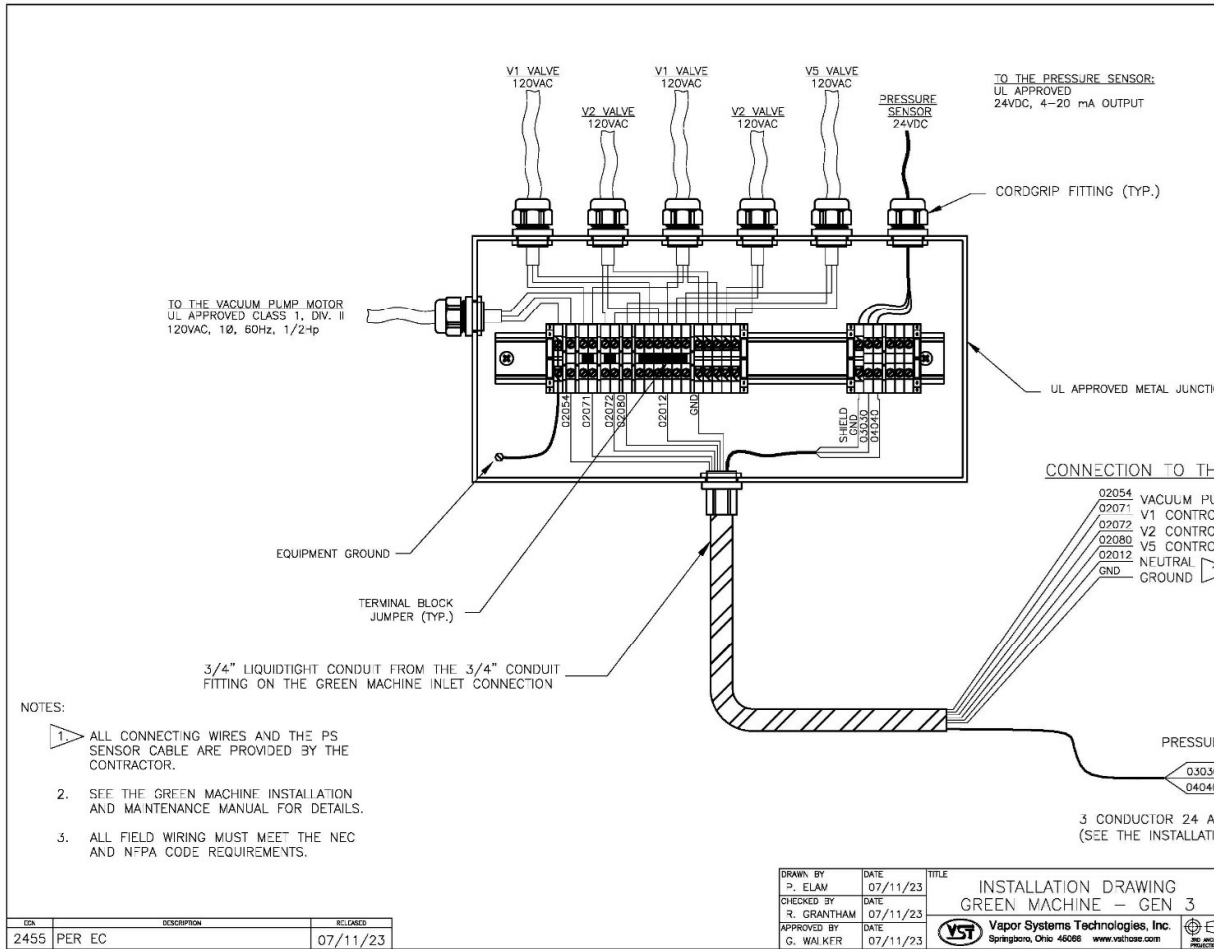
Cableado de campo de la caja de conexiones internas del GREEN MACHINE
